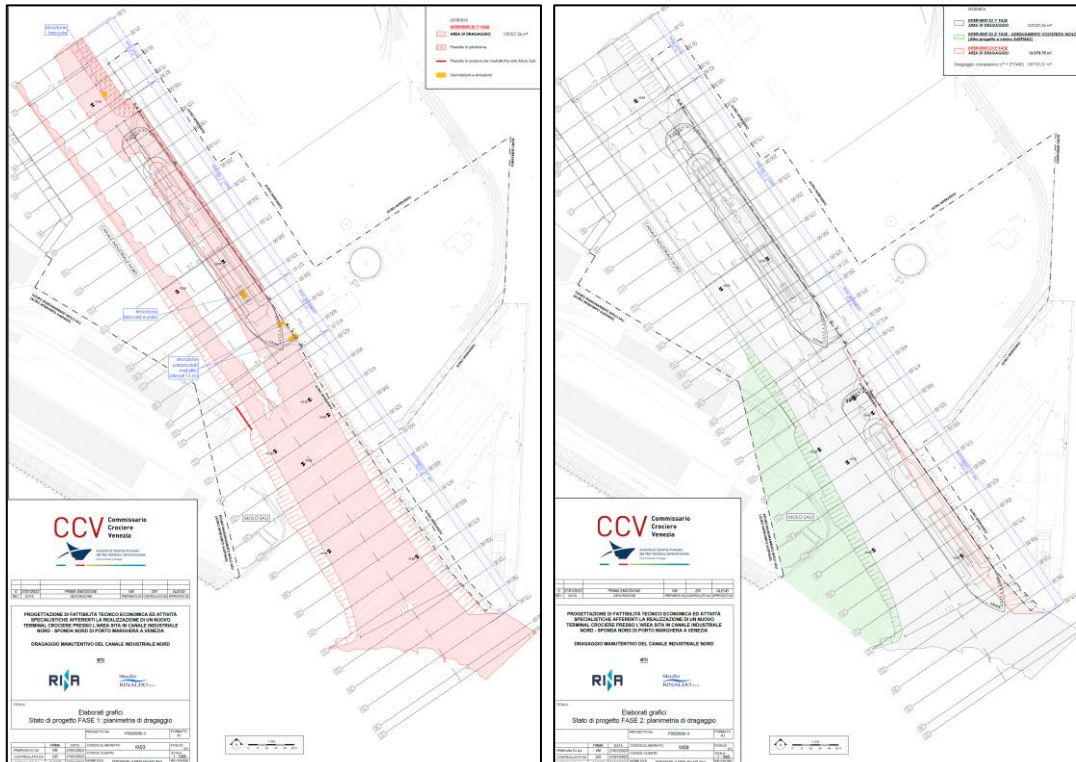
Planimetria dragaggi primo e secondo accosto. Fonte CCV Commissario Crociere Venezia.
